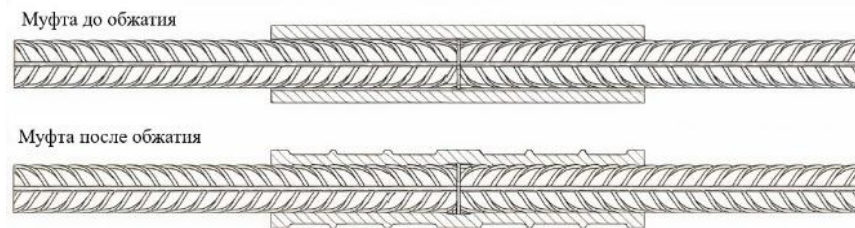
Соединение арматурных элементов (рабочий стык) сваркой и резьбовыми или обжимными муфтами:
